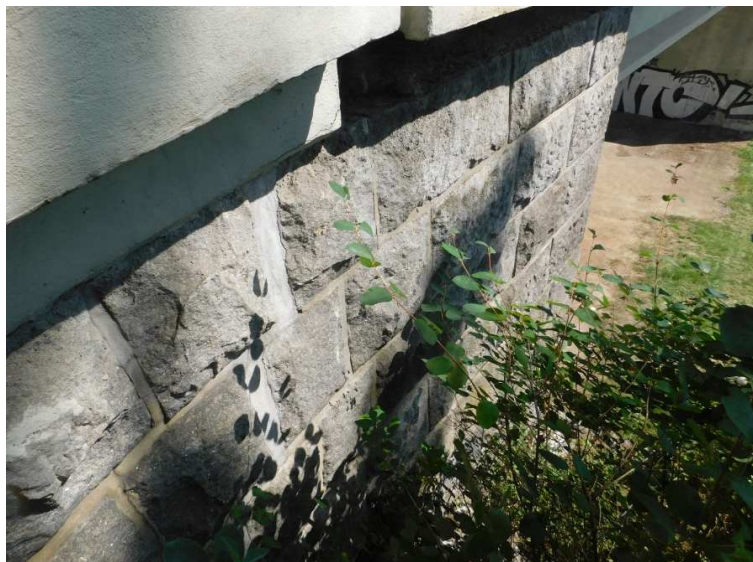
opěra OP1, pohled na levou plentovací zed'
